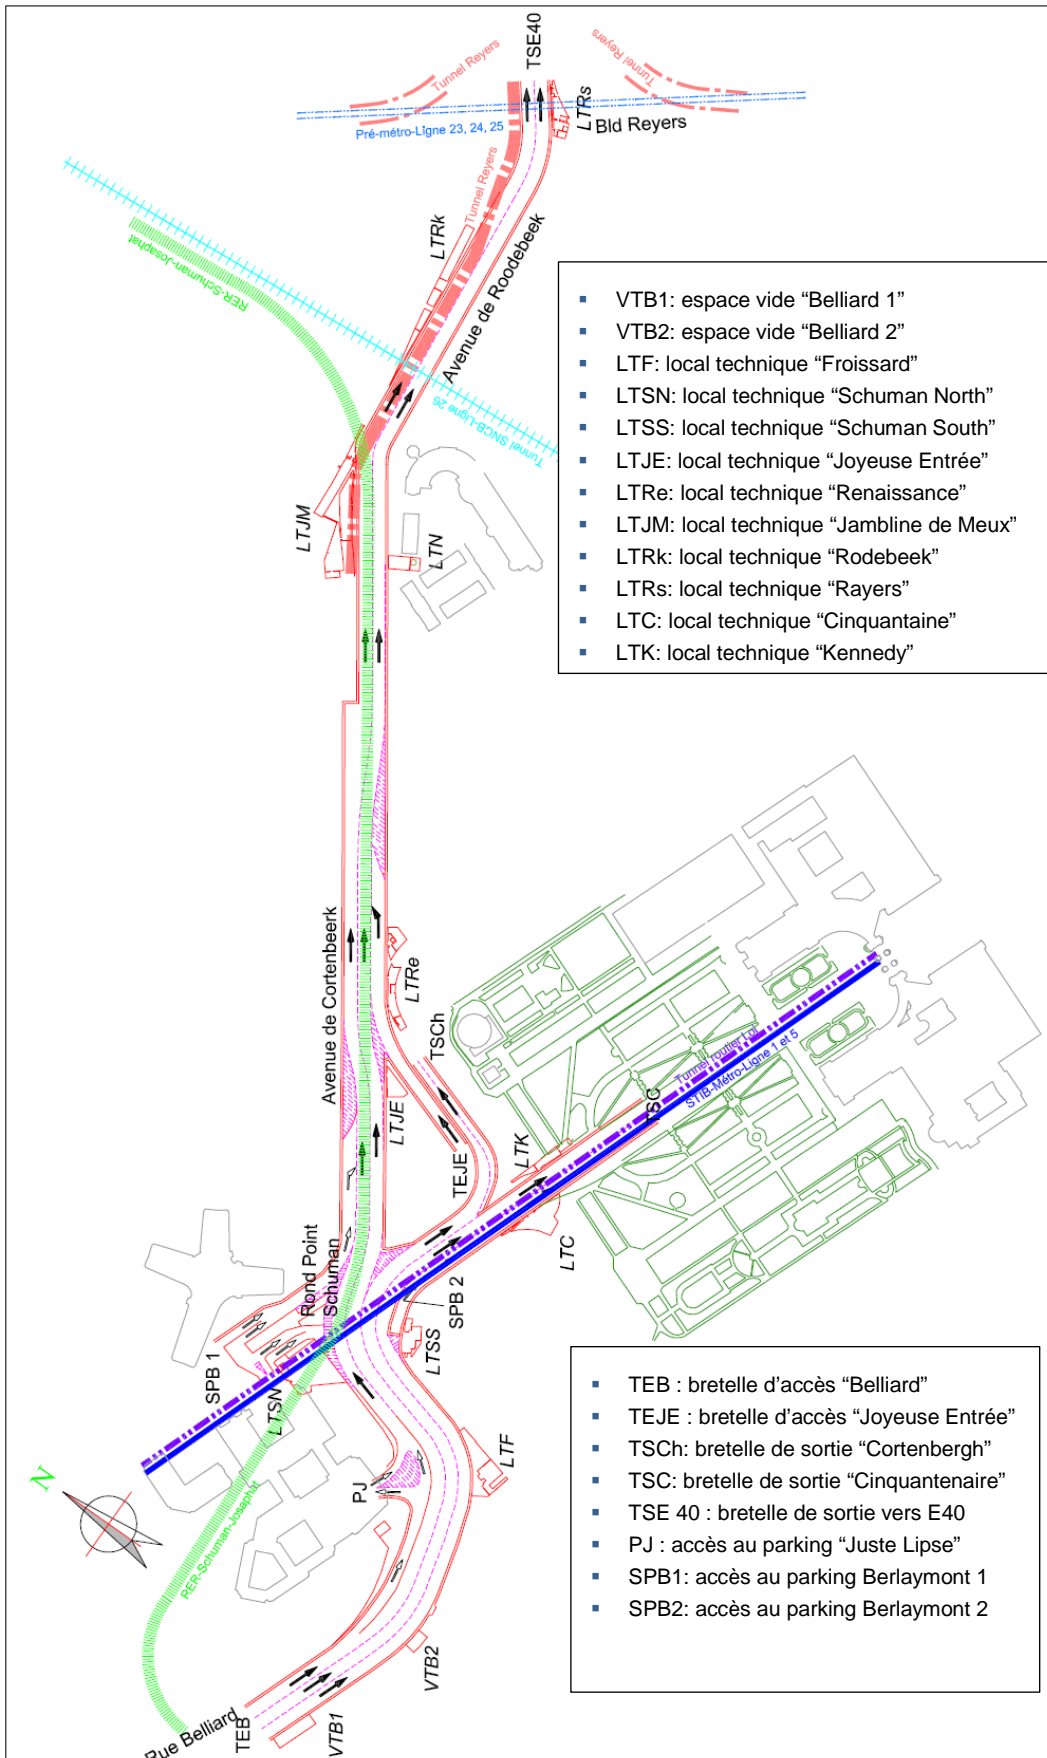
tunnel Belliard tracé en plan – destination des ouvrages souterrains
